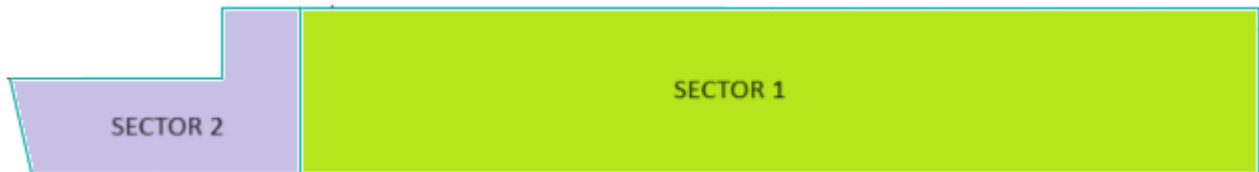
Tipos de pavimento intertrabado en planta (Fuente: Elaboración propia).
